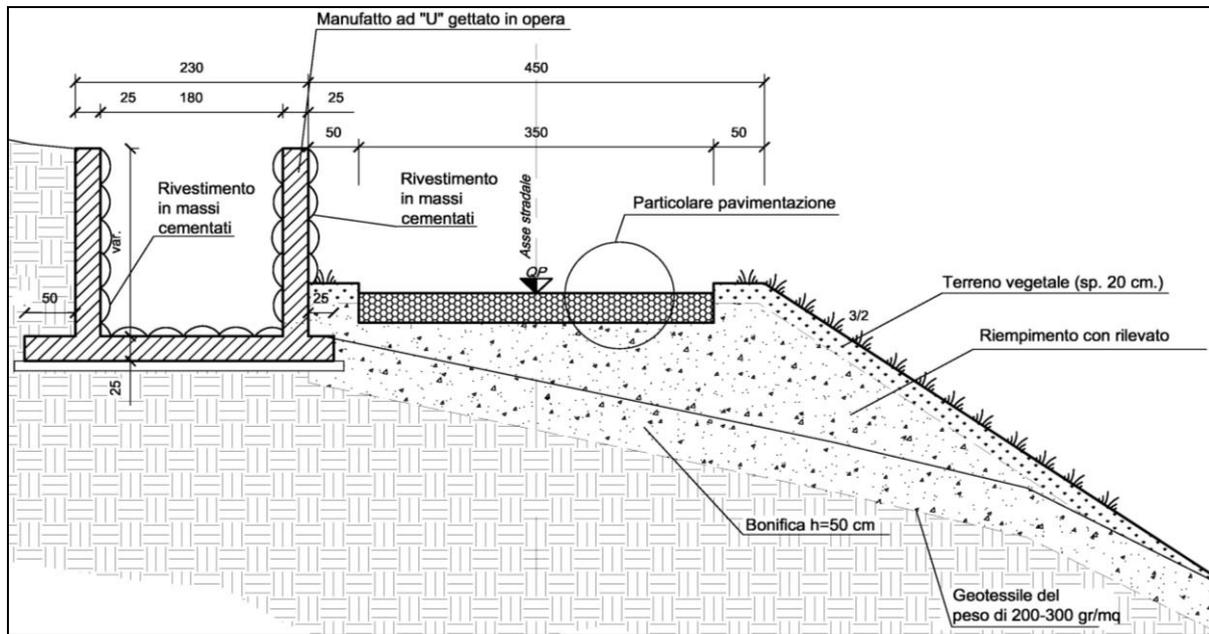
Viabilità di accesso abbancamento – Sezione tipo
